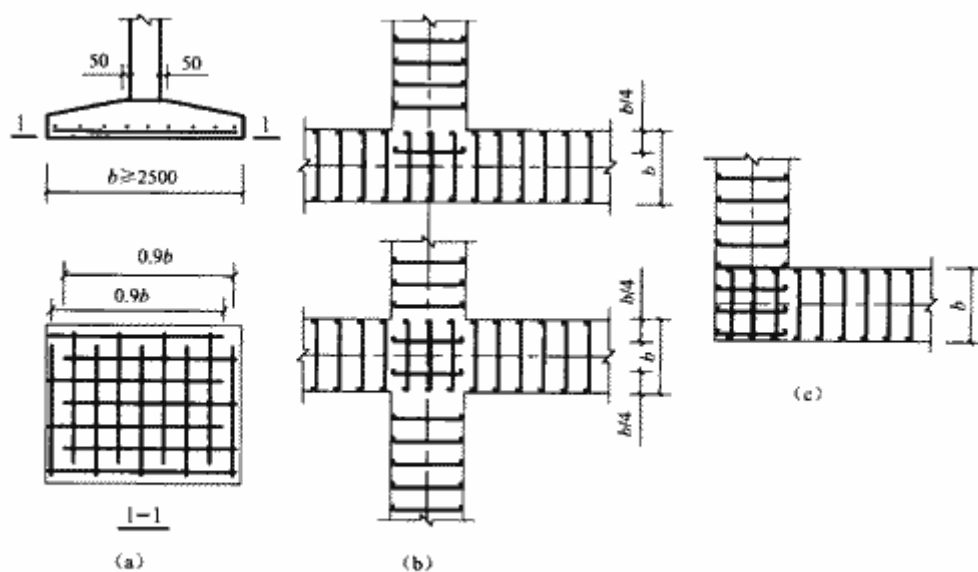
扩展基础底板受力钢筋布置示意图
